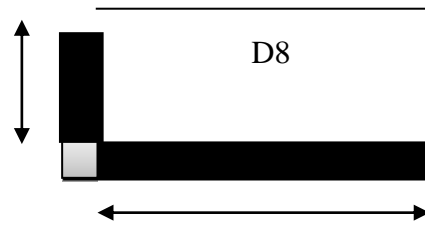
schéma de ferrailage de la dalle plaine sur 3 appuis.
